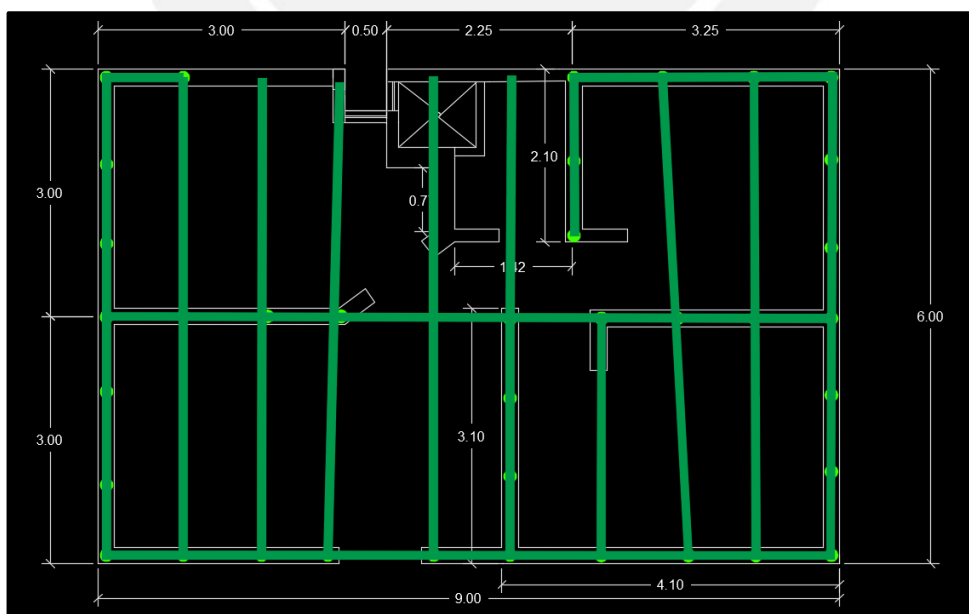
Plano de la vivienda B a nivel de techos. Se indica la ubicación de las viguetas de bambú sobre las que se soportará el techo de drywall y policarbonato.
